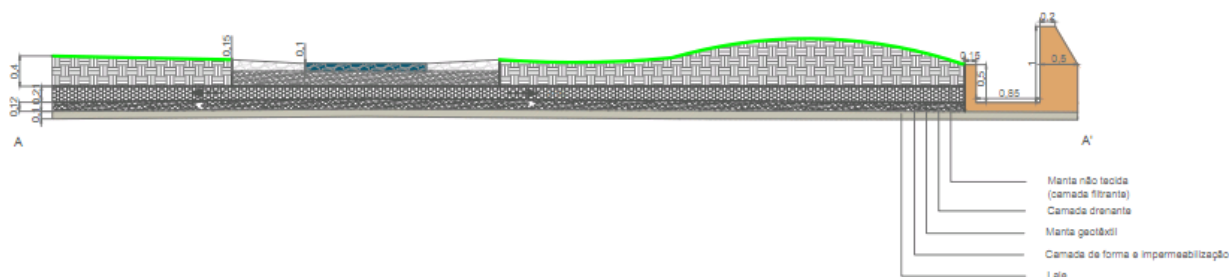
Levantamento: Pormenor de construção relativo ao terraço C e representa a modelação de terreno com representação da bacia de retenção com calhaus rolados e o murete
